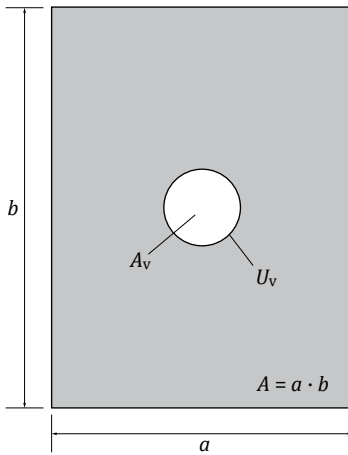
Grundfläche eines rechteckigen Lagers mit Bohrung [2]
